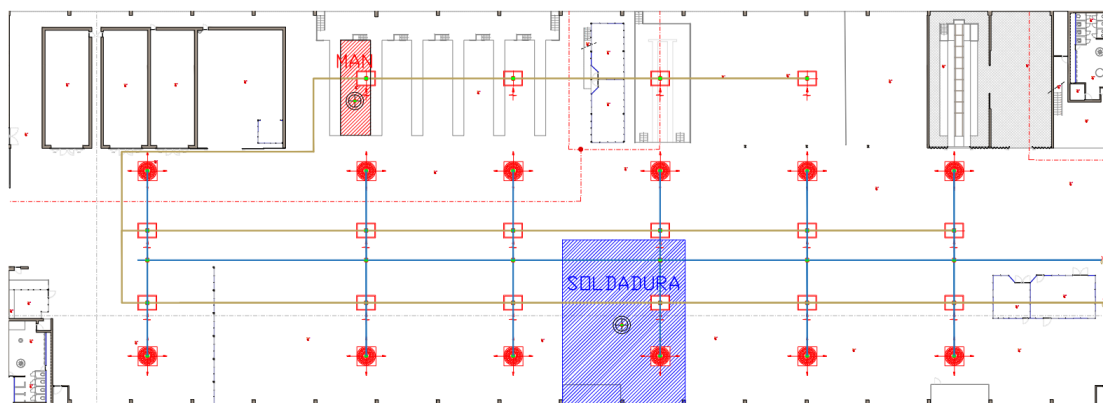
Configuração proposta (azul – Insuflação, castanho – extração, preto – extração localizada).
